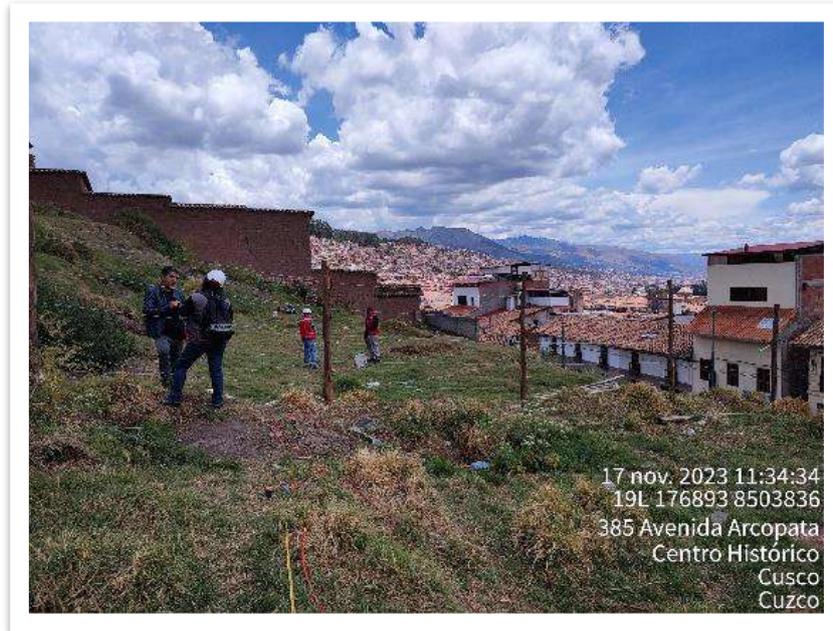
Excavación de calicata CSP-01 para la extracción de muestra para los ensayos de EMS para la estabilidad de taludes del perfil B-B'
